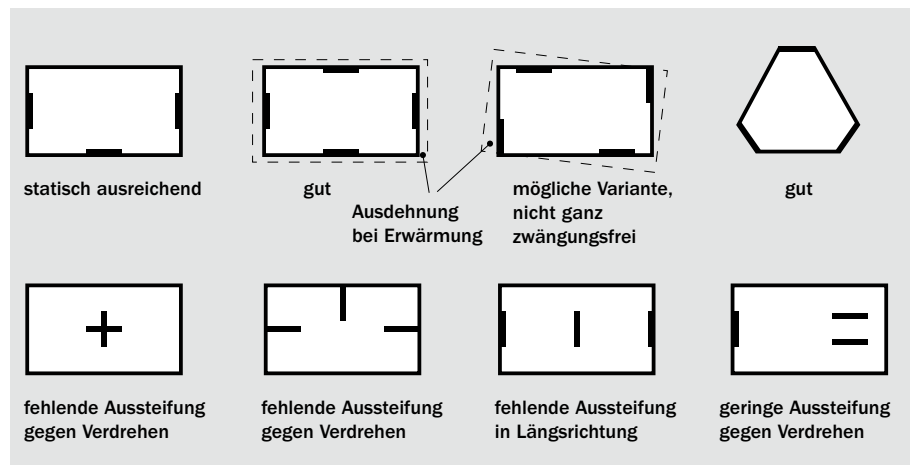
Günstige und ungünstige Anordnung von Wandscheiben im Grundriss (nach [14])
